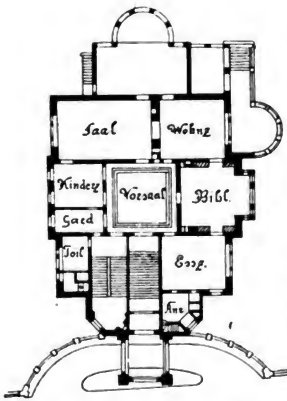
und 453. Wohnhaus F. Schütte. Grundrisse der beiden Hauptgeschosse und Portal. Heinr. Müller.
